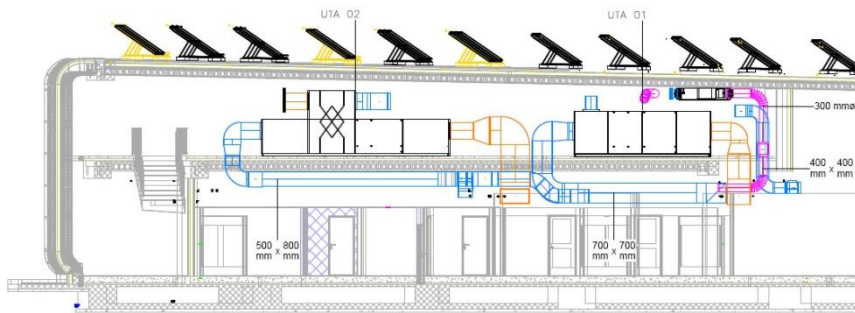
Fabbricato ATC piano terreno: sezione e unità di ventilazione su copertura
